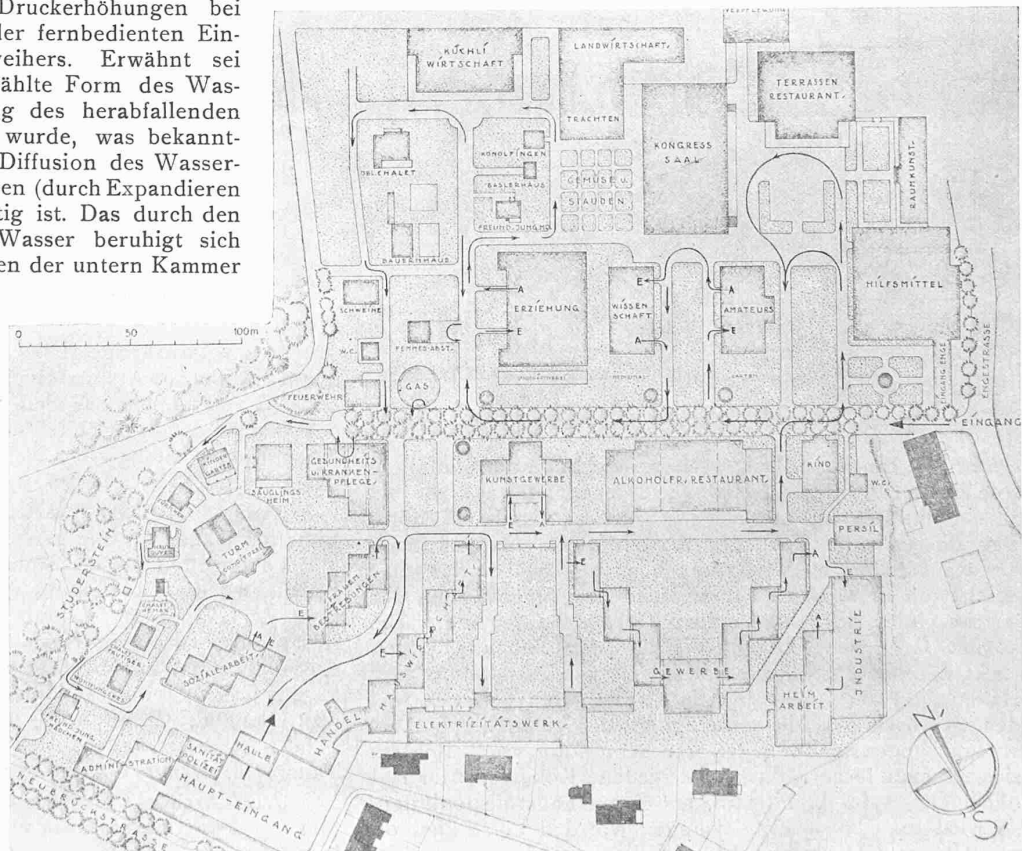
Lageplan der „Saffa“, Schweizer. Ausstellung für Frauenarbeit. — 1 : 3000.
